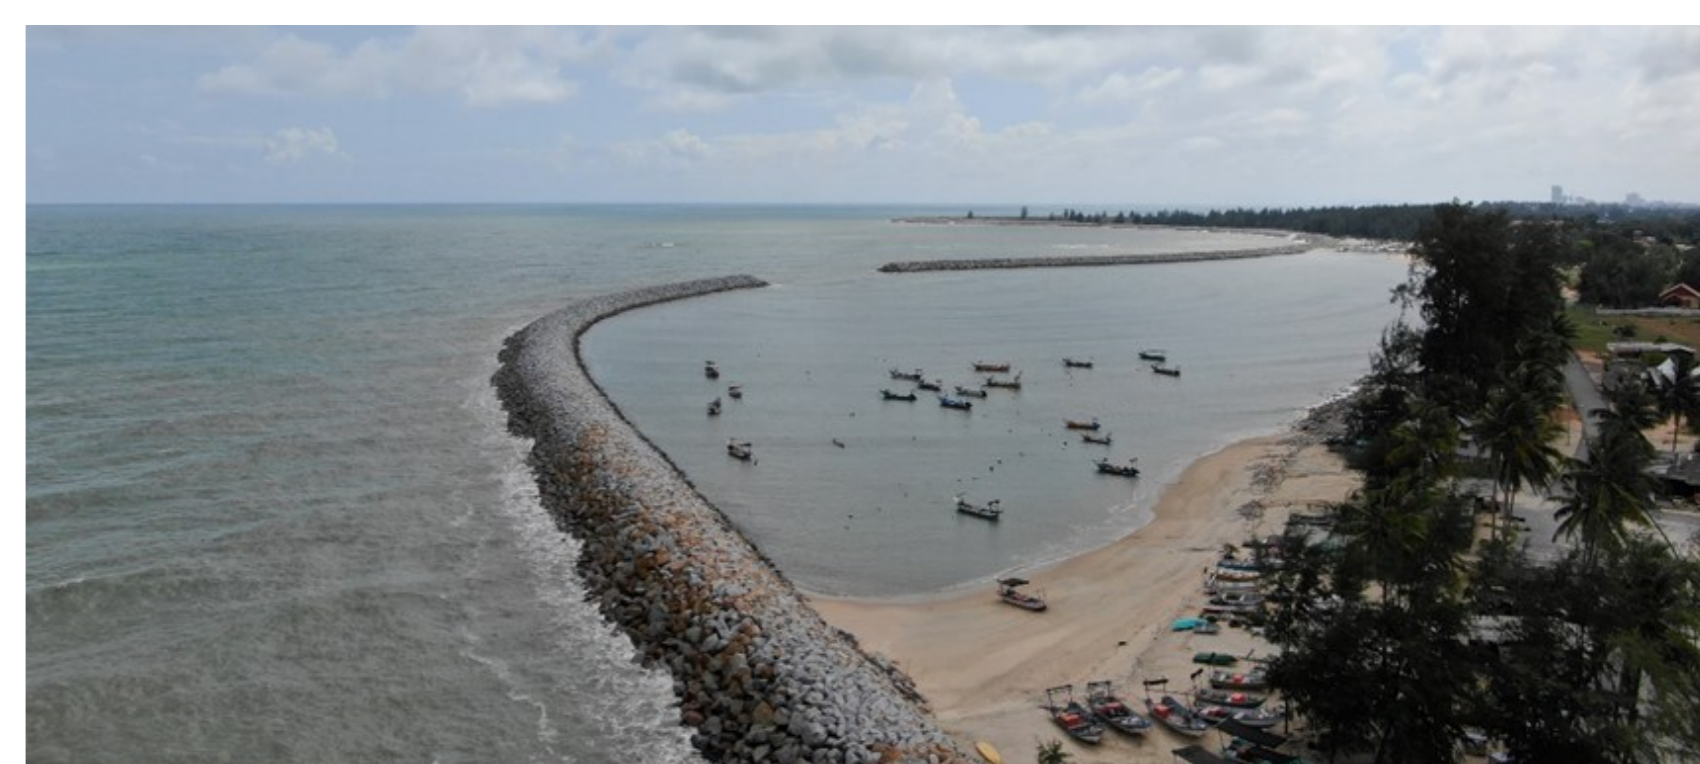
Jalan pantai baru dan lapis-lindung sepanjang jalan Pantai Teluk Ketapang .
